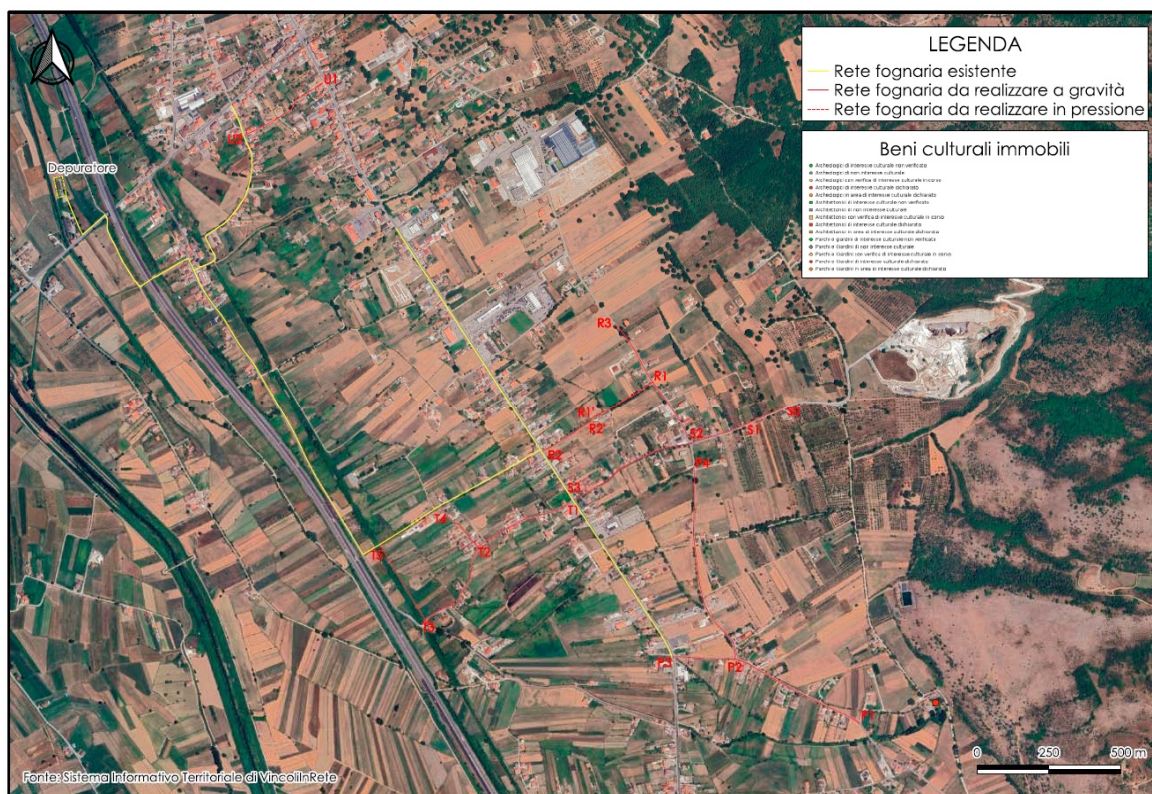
Stralcio della planimetria della rete fognaria esistente e di progetto
